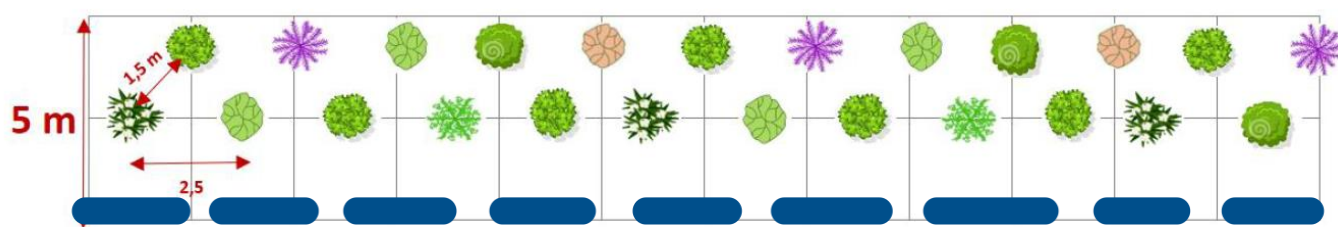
Planimetria fascia di mitigazione e recinzione perimetrale
